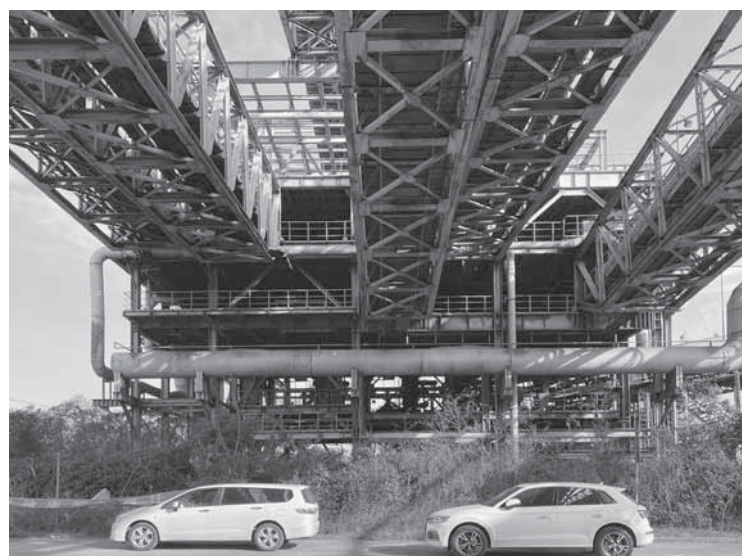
| Stato di fatto, prospetto ovest (© Terrence Zhang)
